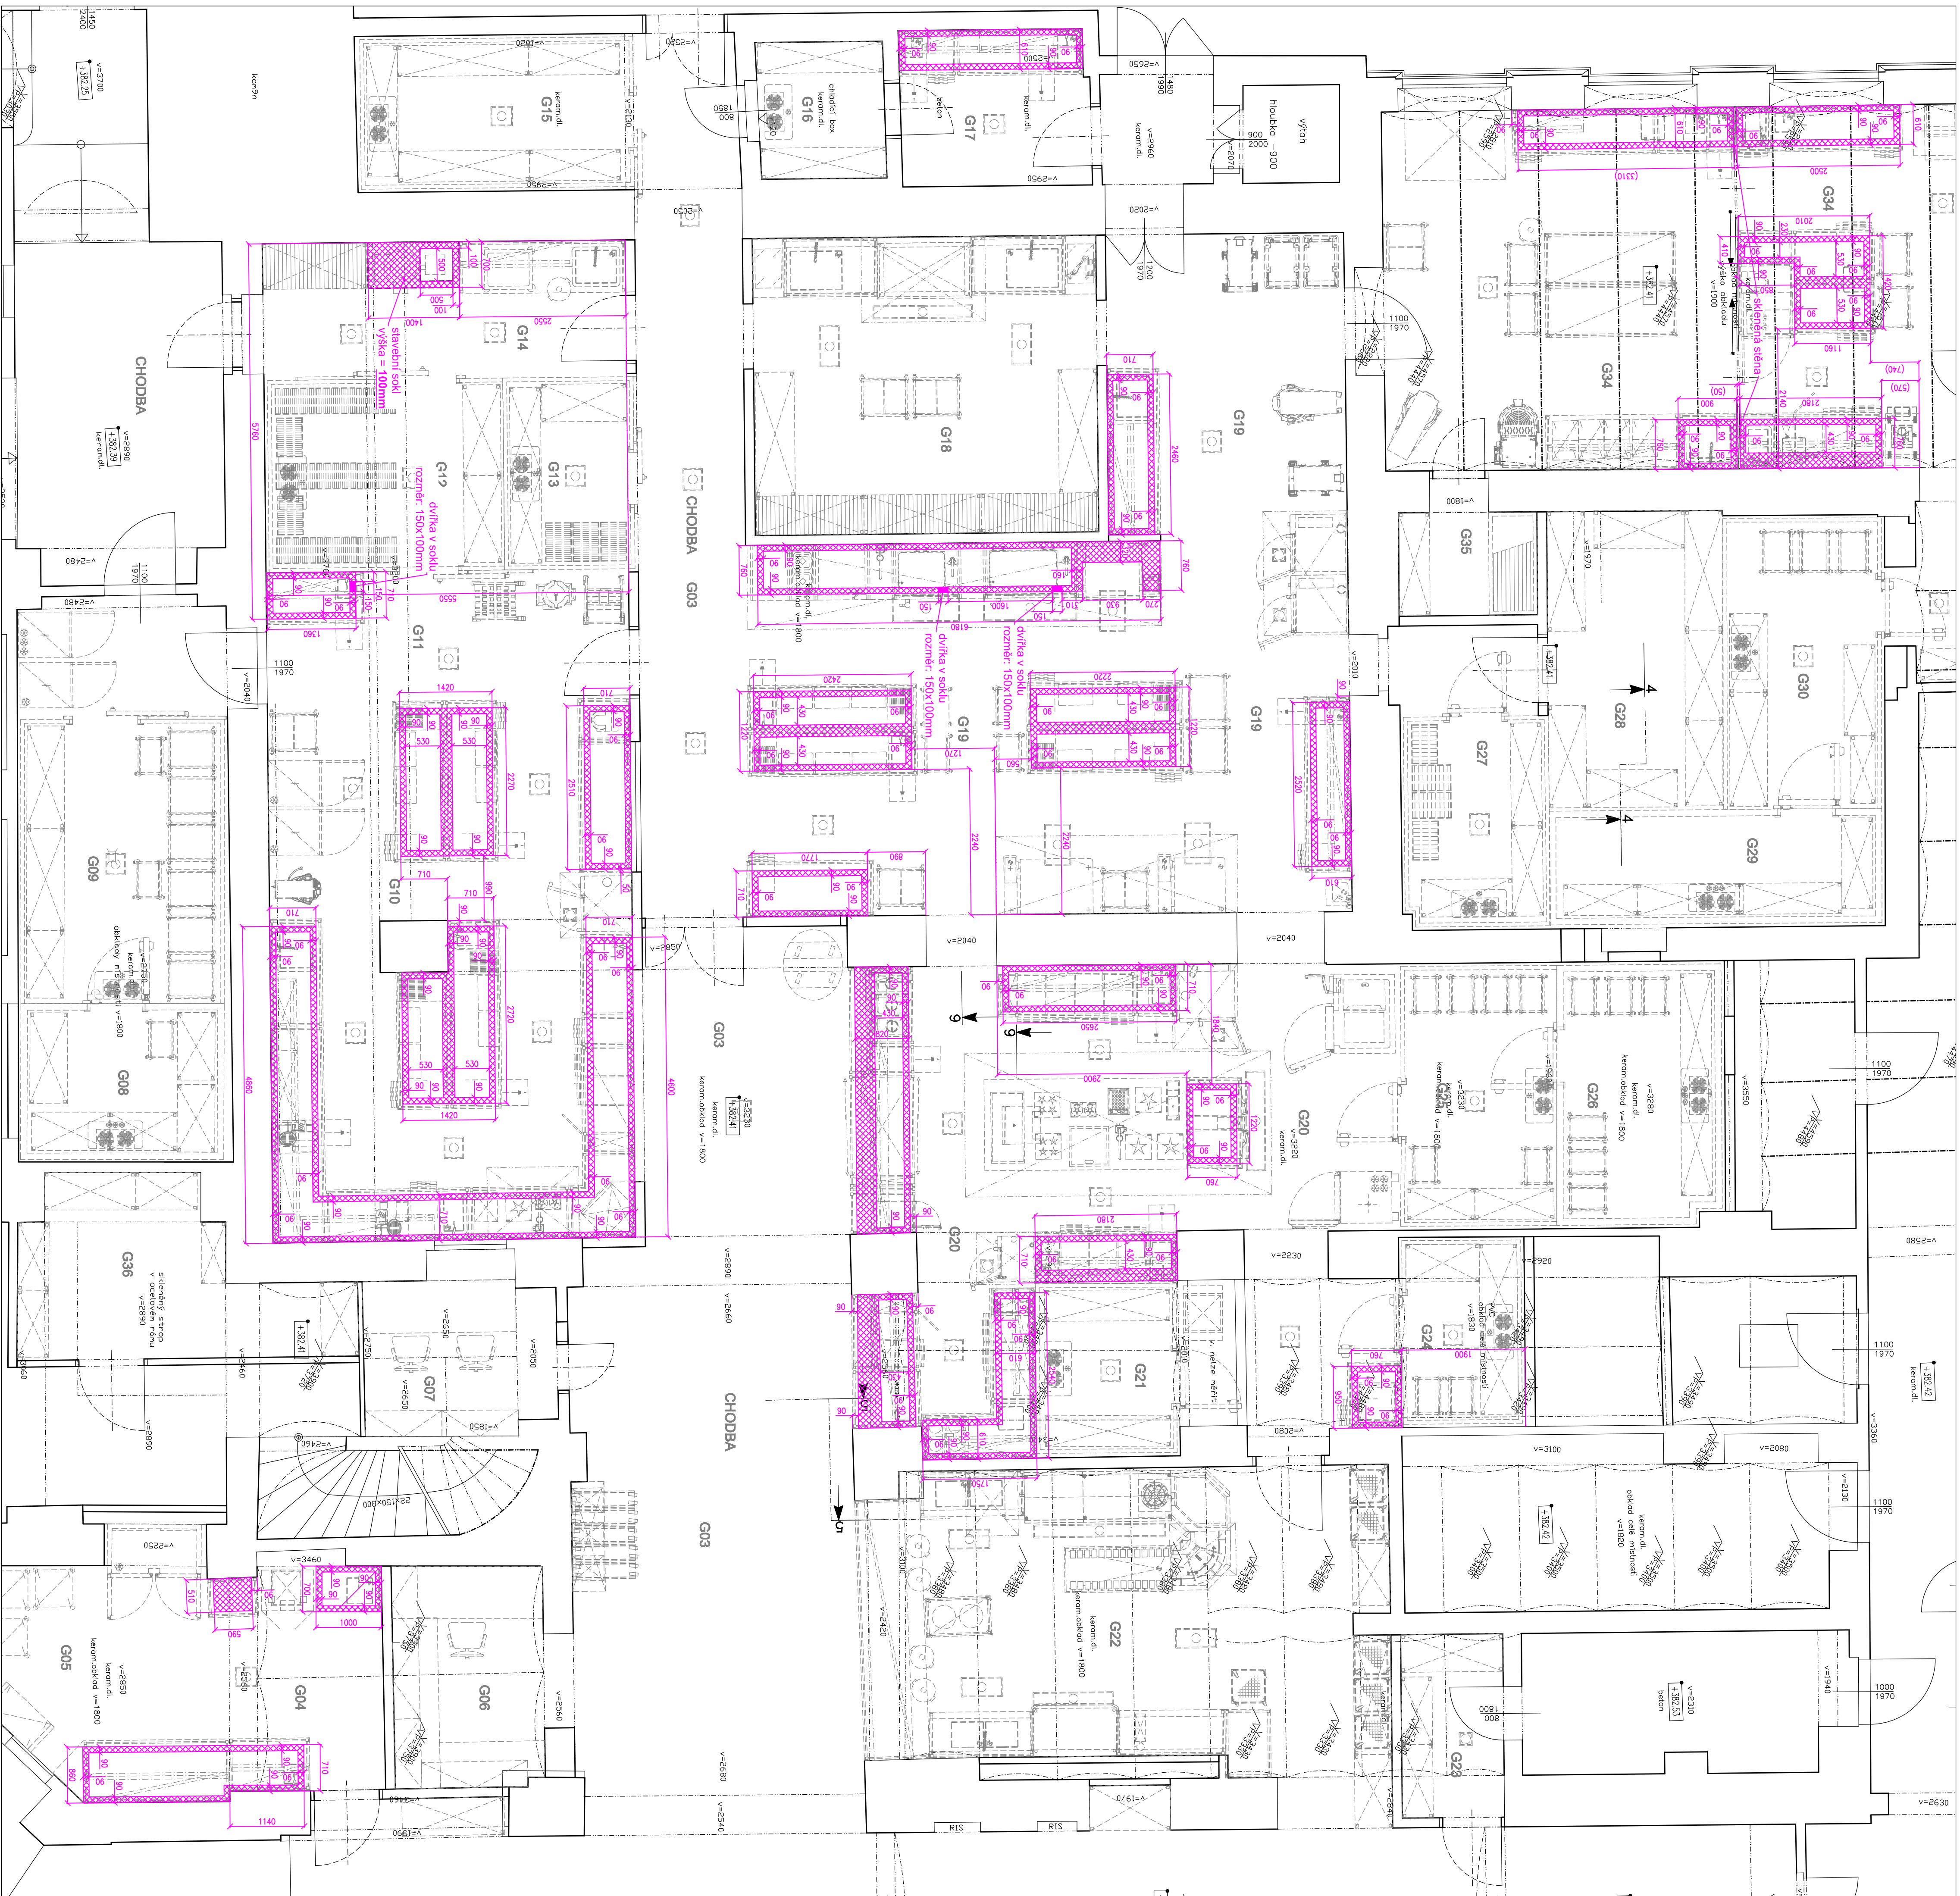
DETAIL UMÍSTĚNÍ BETONOVÉHO SOKLU POD TECHNOLOGII GASTRO
